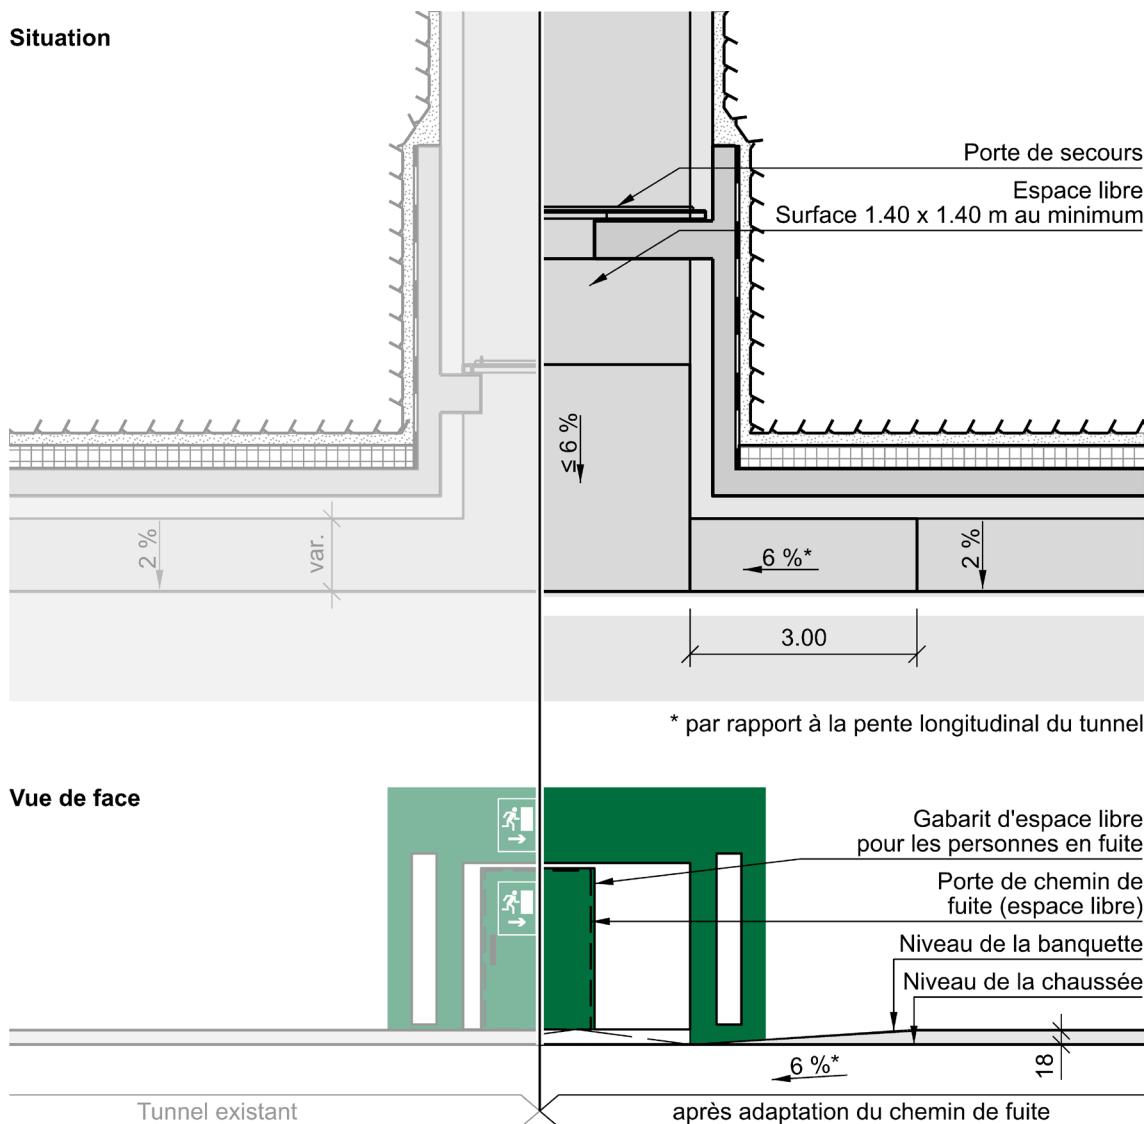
Sortie de secours en Situation et en Vue de face – Adaptation du tunnel existant en abaissant la banquette et en déplaçant la porte de secours dans le sens de la fuite
